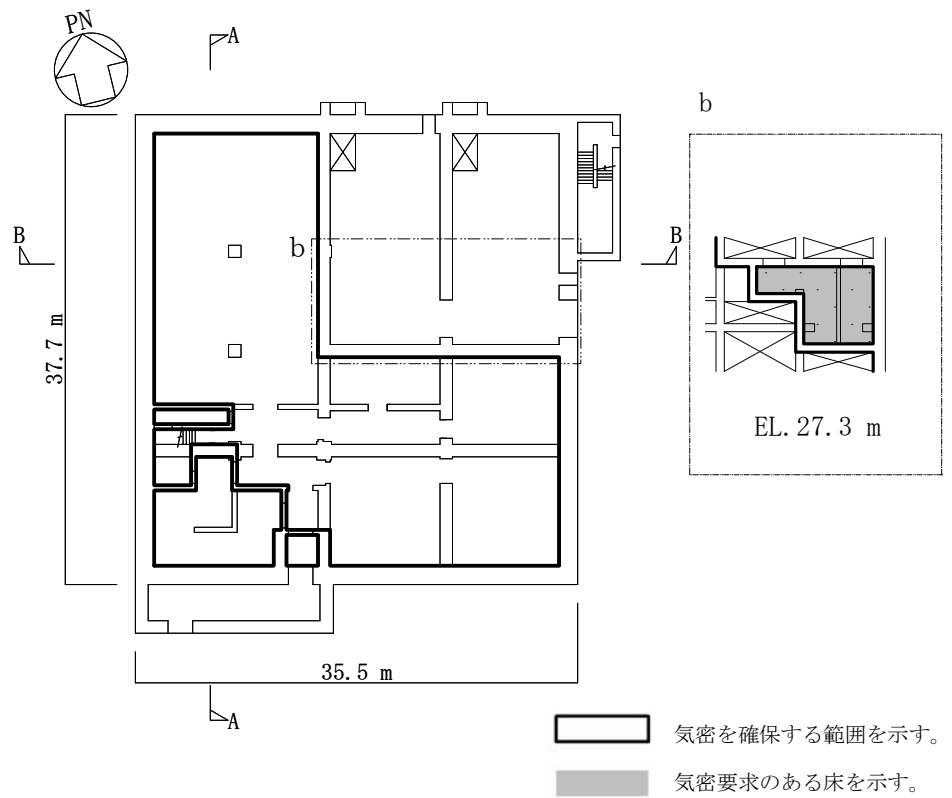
(1/7) 気密性を確保する範囲 (1 階平面図 : EL. 23.3 m)
